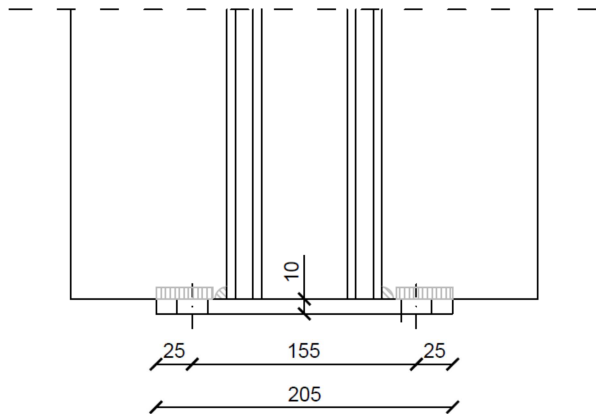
Vista in pianta del collegamento di continuità dei montanti ad T
